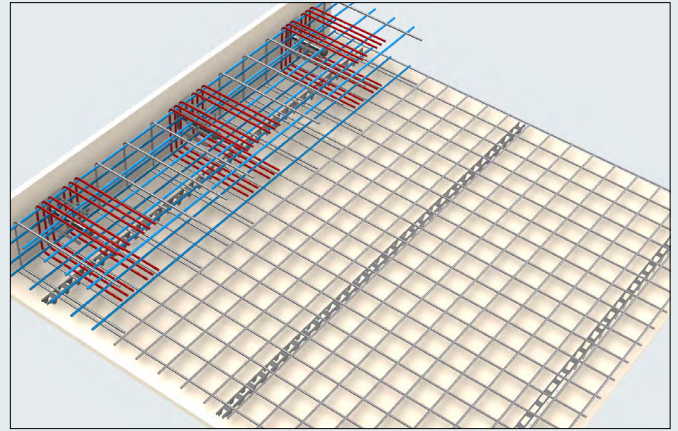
Restliche Zulagebewehrung je Dorn verlegen (Abstände beachten).
